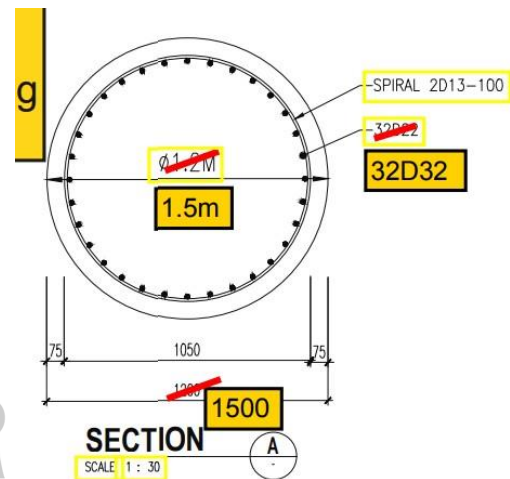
47 Shop drawing detail tulangan bored pile type G section C
